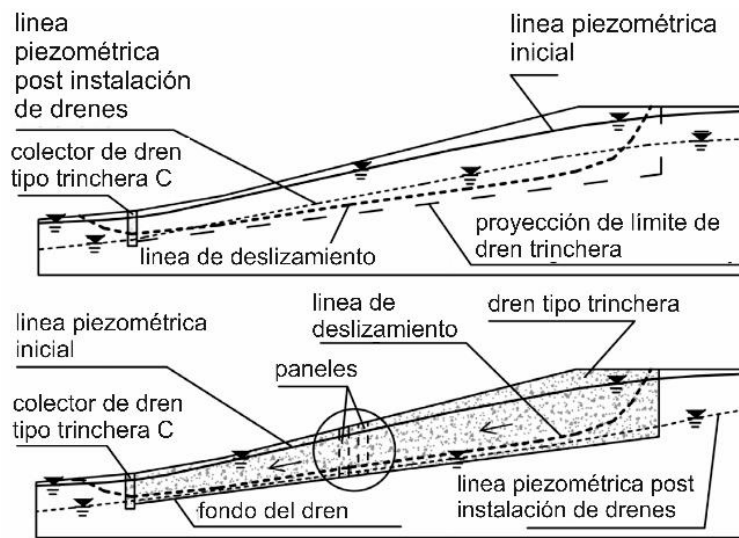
Drenes en los cuales puede emplearse hormigón drenante [49].
